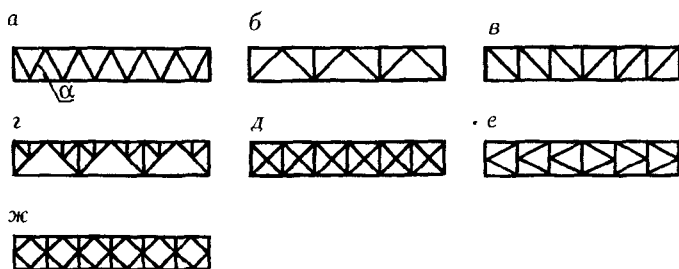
Типы решеток ферм: а — треугольная; б — треугольная со стойками; в — раскосная, г — шпренгельная; д — крестовая; е — полукасосная; ж — ромбическая
